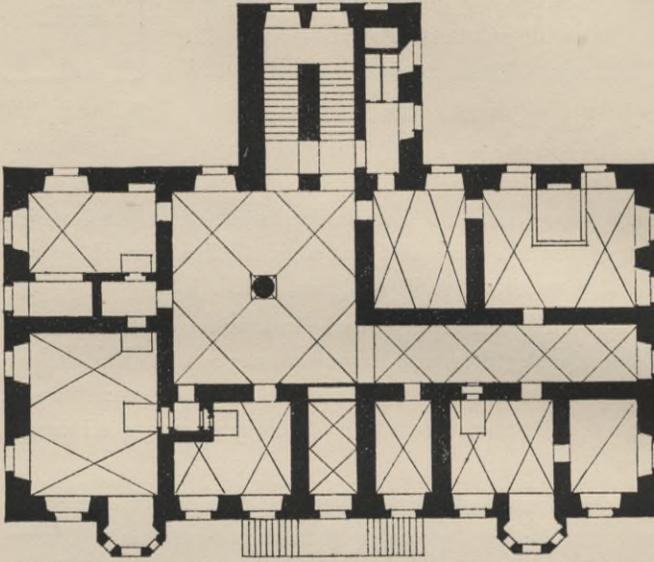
Bonndorf. Grundriss des Schlosses.
